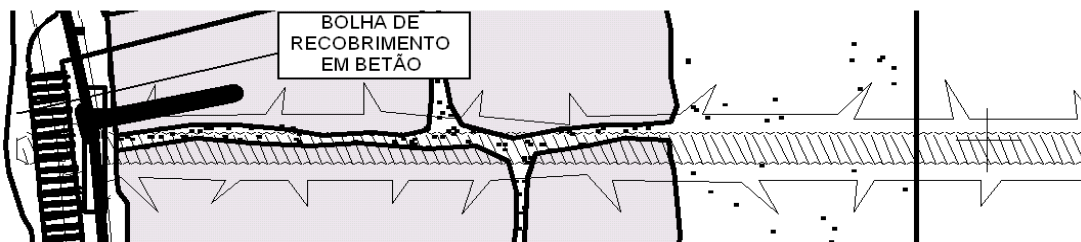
Pormenor de uma bolha de recobrimento em betão (adapt. de GEG)
